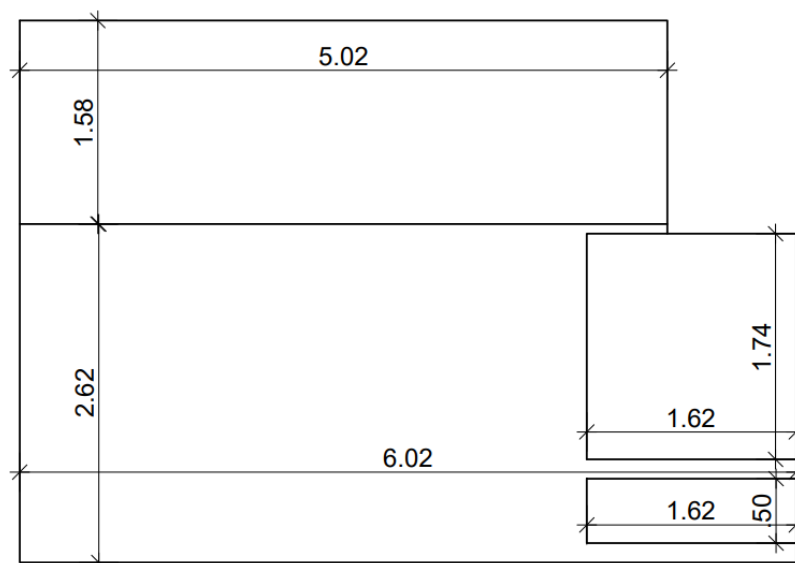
Medidas da escada, poço do elevador, shaft e hall do pavimento salão para os cálculos das áreas.
